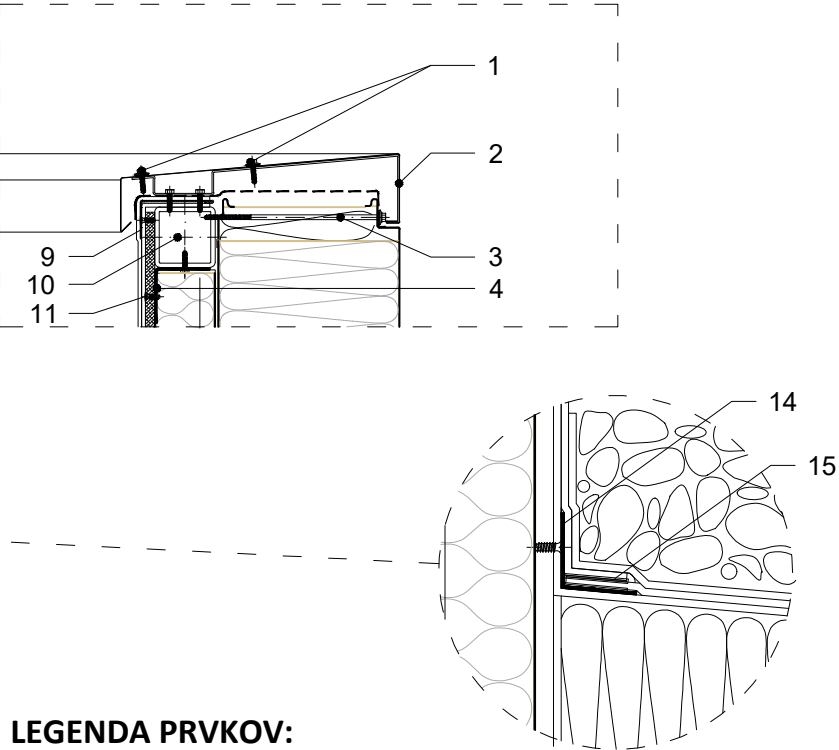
ATIKY FASÁDNÝCH PREFABRIKOVANÝCH SENDVIČOVÝCH PANELOV
